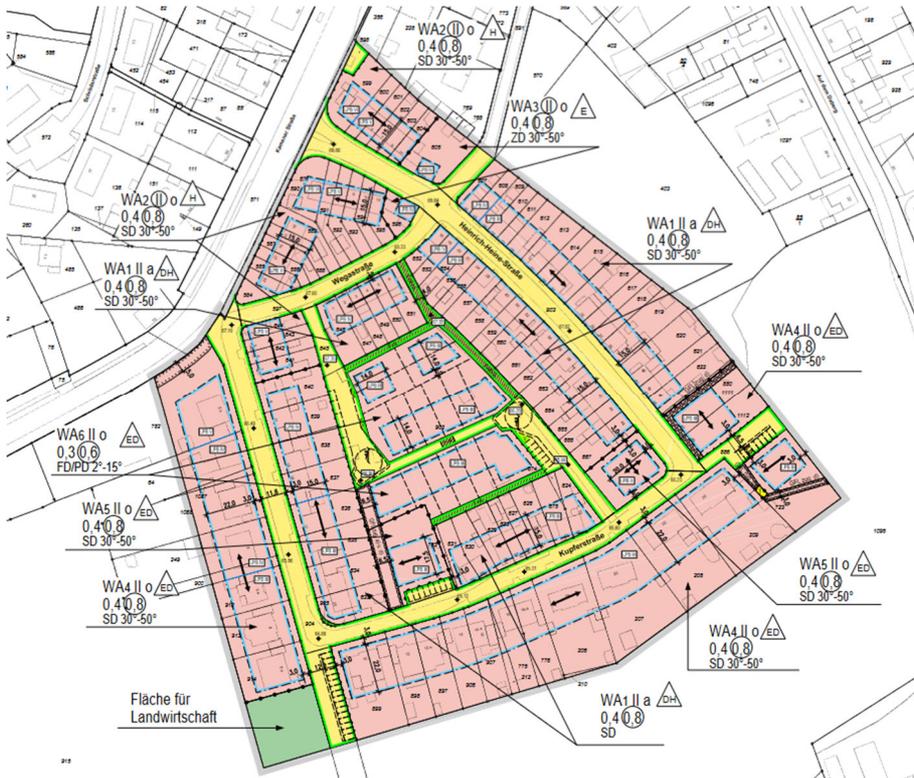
Auszug Bebauungsplan 04.075 Kupferstraße
